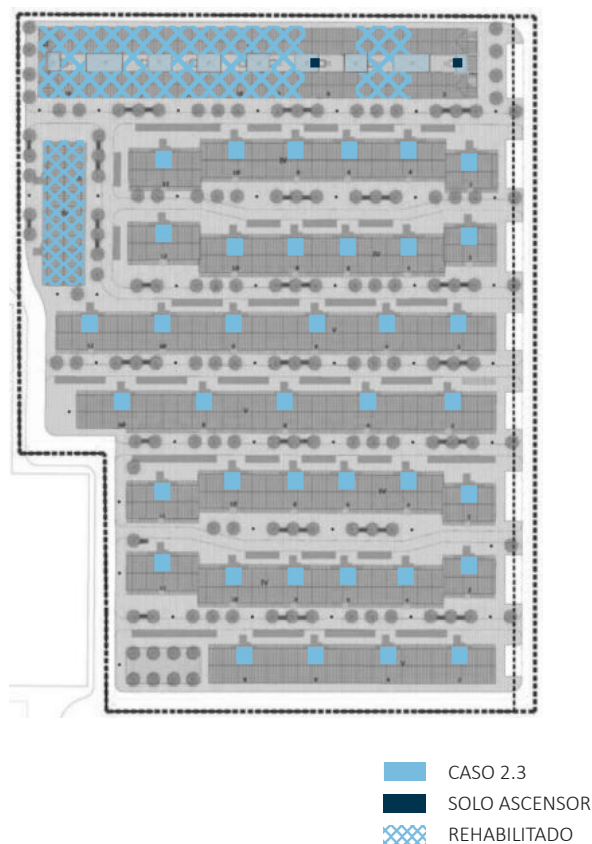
Estandarización de la solución en el Conjunto Picarral (Fase I y Fase II).
